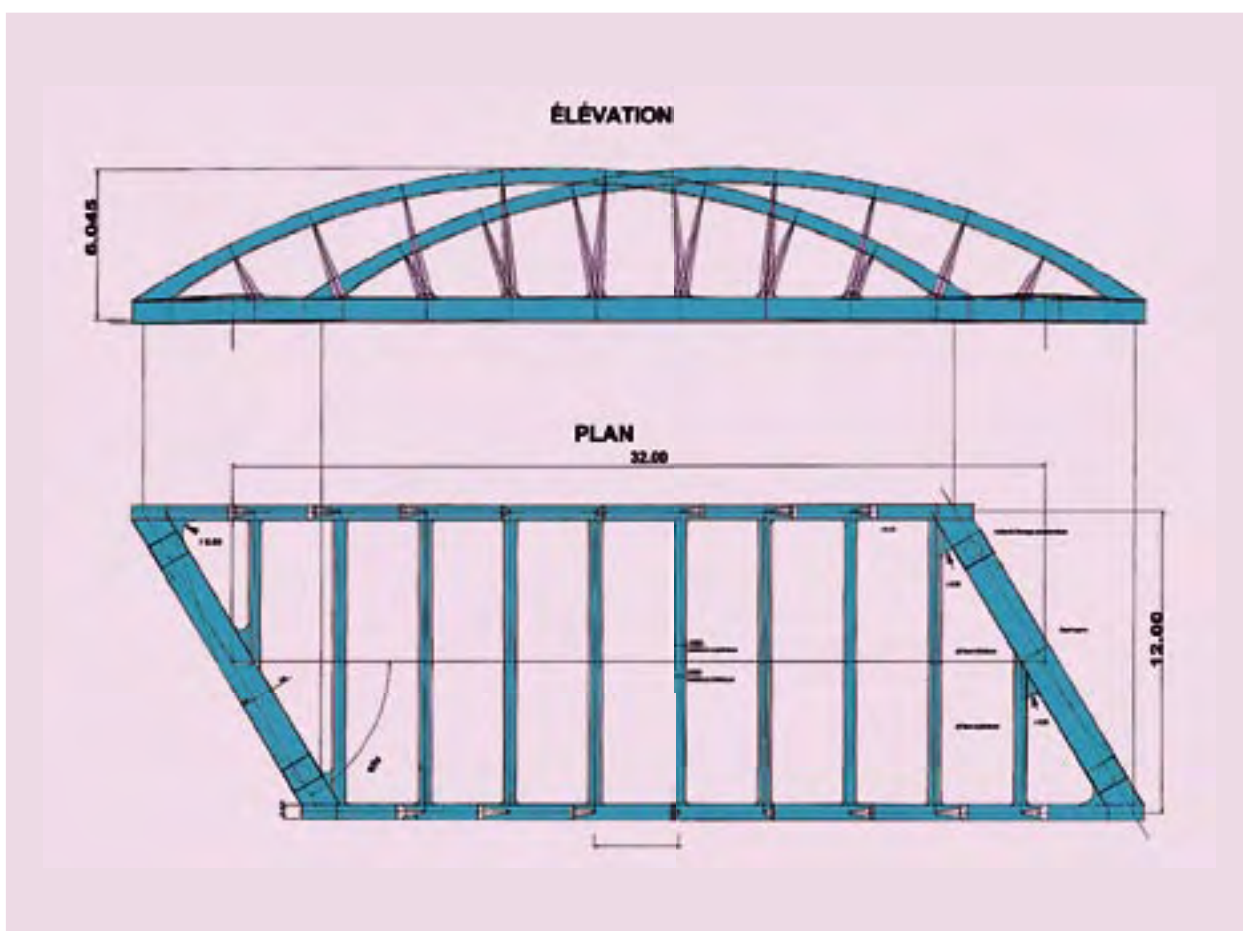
plans généraux du pont en arc proposé par le Sétra
